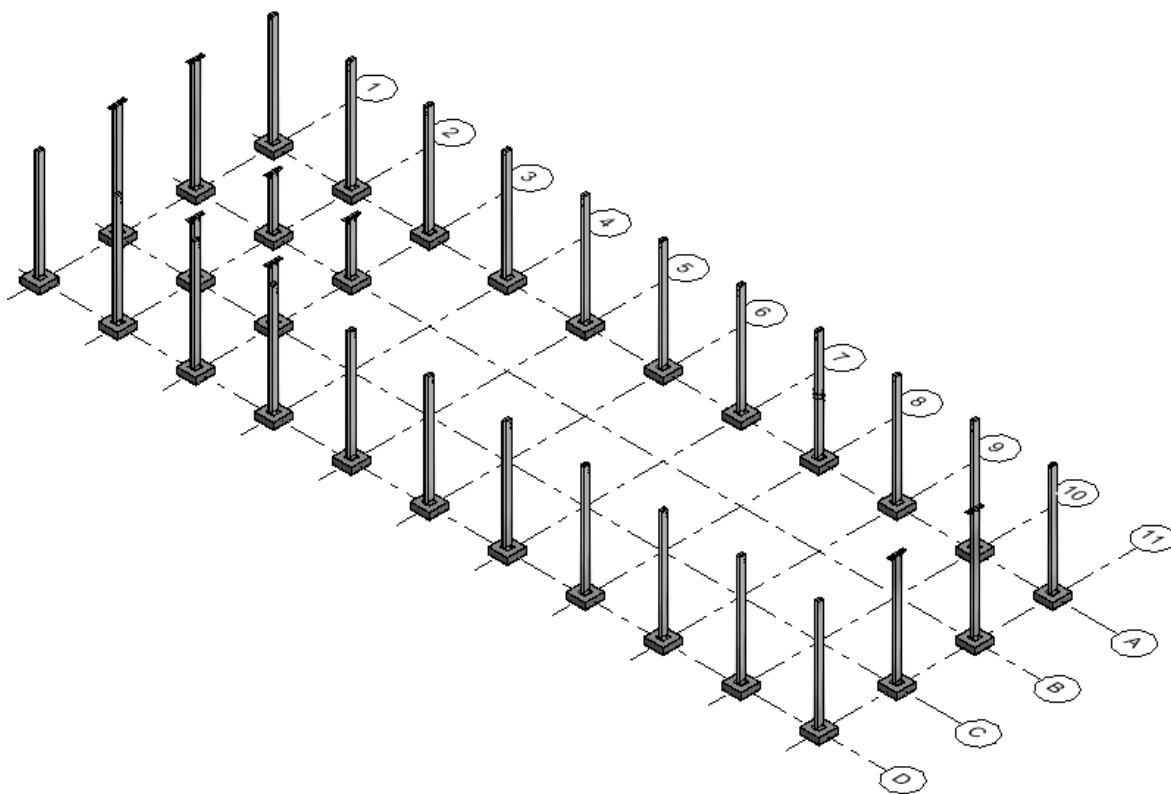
Imatge del posicionament dels pilars metàl·lics perfil HEB450 de la nau. (Font: "Revit")
